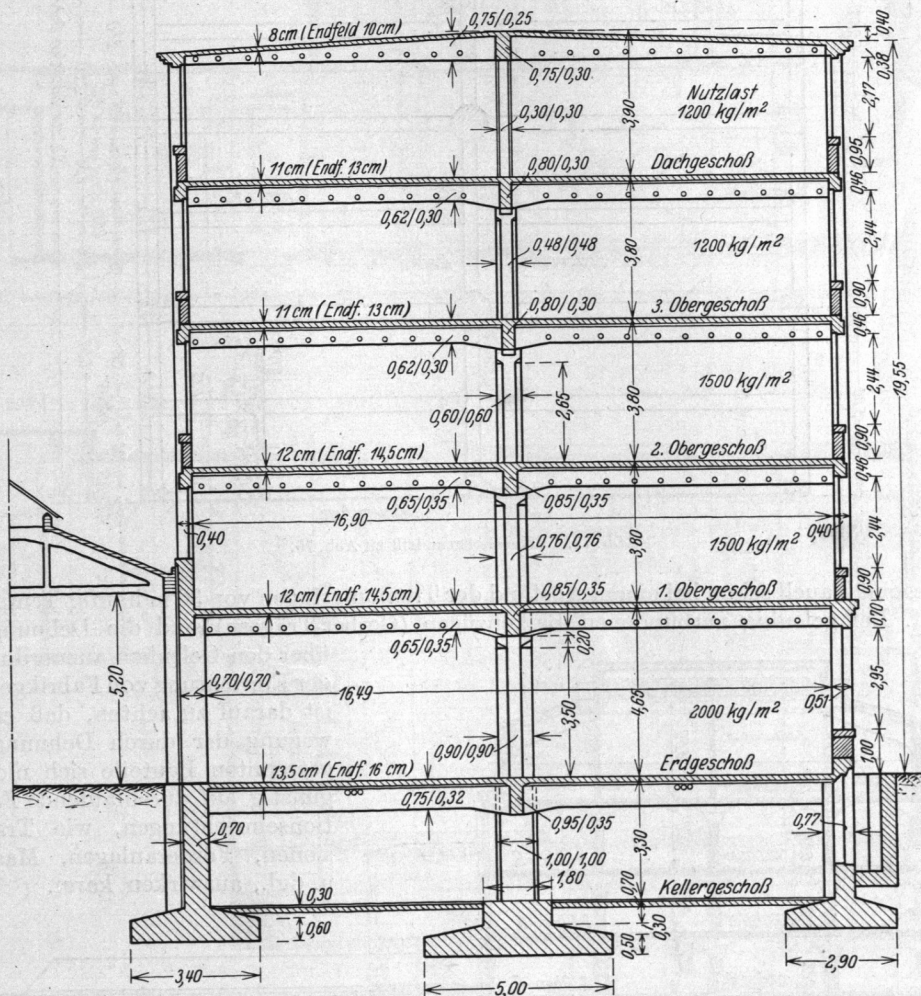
Querschnitt eines Eisenbeton-Stockwerksbaues.
